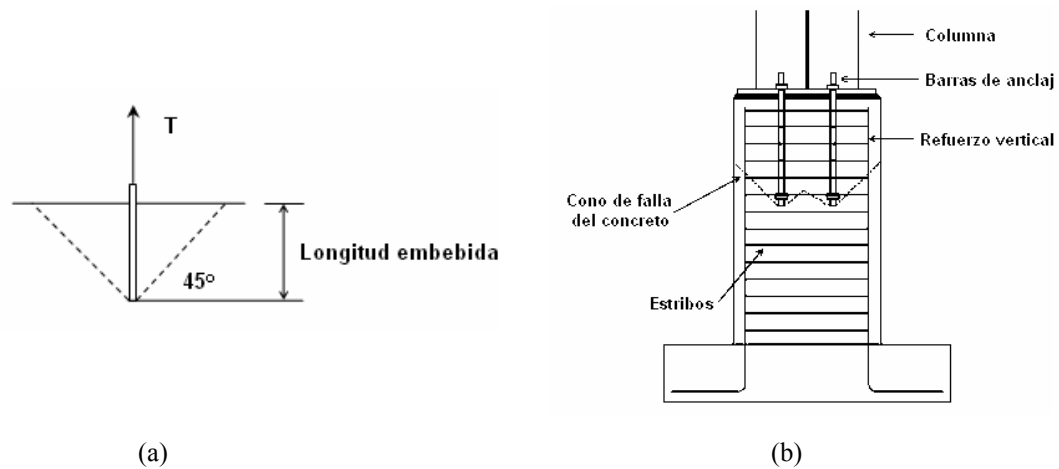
Conos de falla en el concreto; (a) completo, en un anclaje aislado (Newman, 2004); (b) solapado parcialmente.
